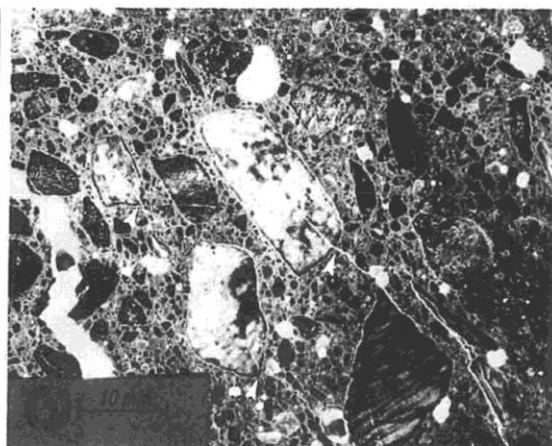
Bildet viser en detalje av planslip D4/5 fotografert i fluorescerende lys. Merk riss og soneringer om reagerede tilslag (piler)
